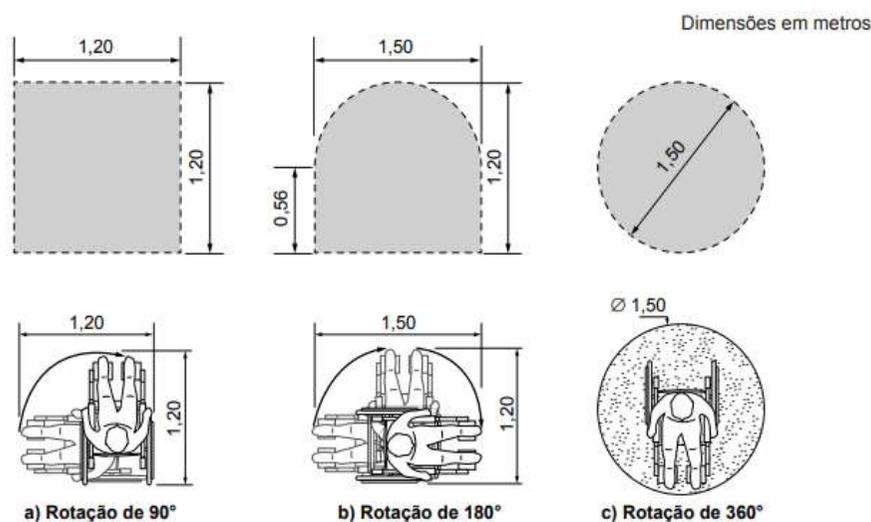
Dimensões mínimas para giro da cadeira de rodas - imagem retirada NBR 9050
